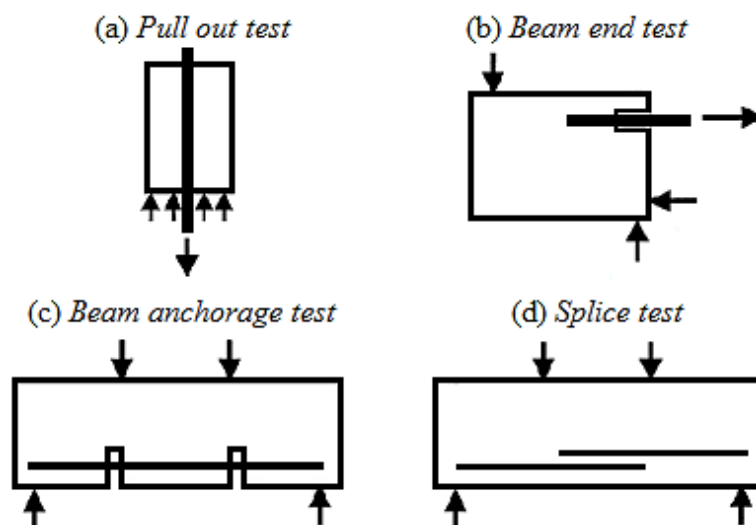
Configurações de ensaio recomendadas pela ACI Committee 408 (2003).
